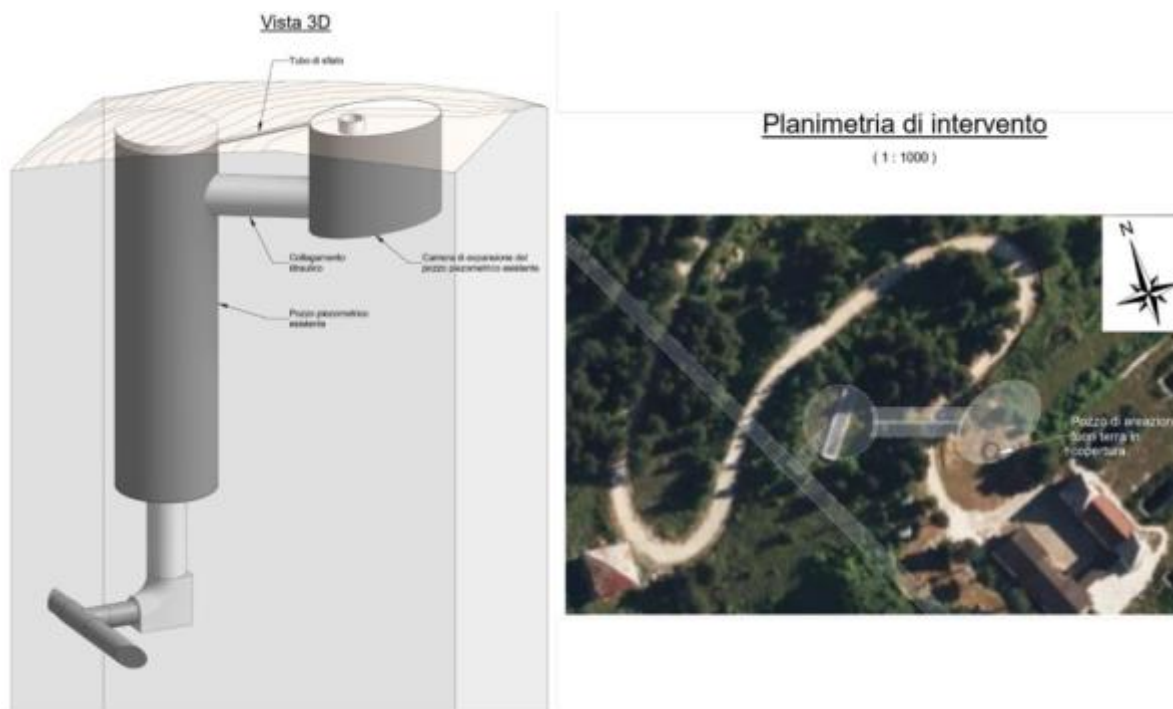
Nuova camera di espansione al pozzo piezometrico sulla derivazione Provvidenza – vista 3D e planimetria d'intervento
